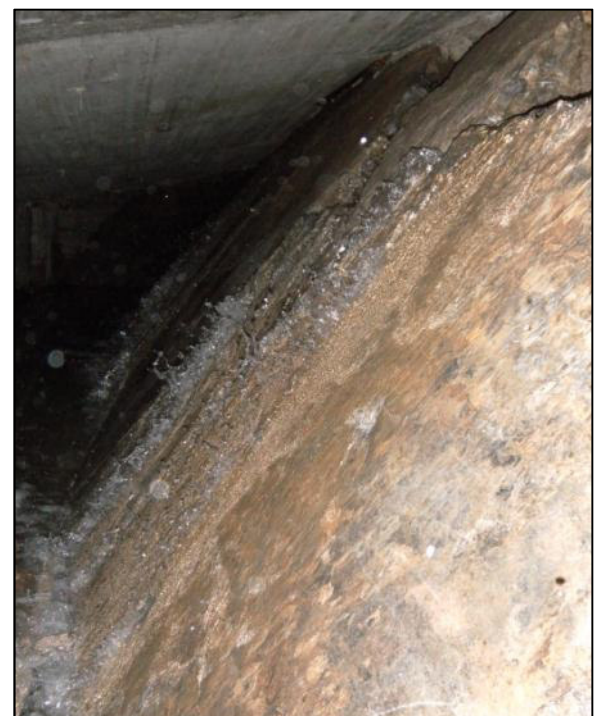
und 5: Riss in der Decke, Detail eines Risses mit abgerissener Bewehrung
